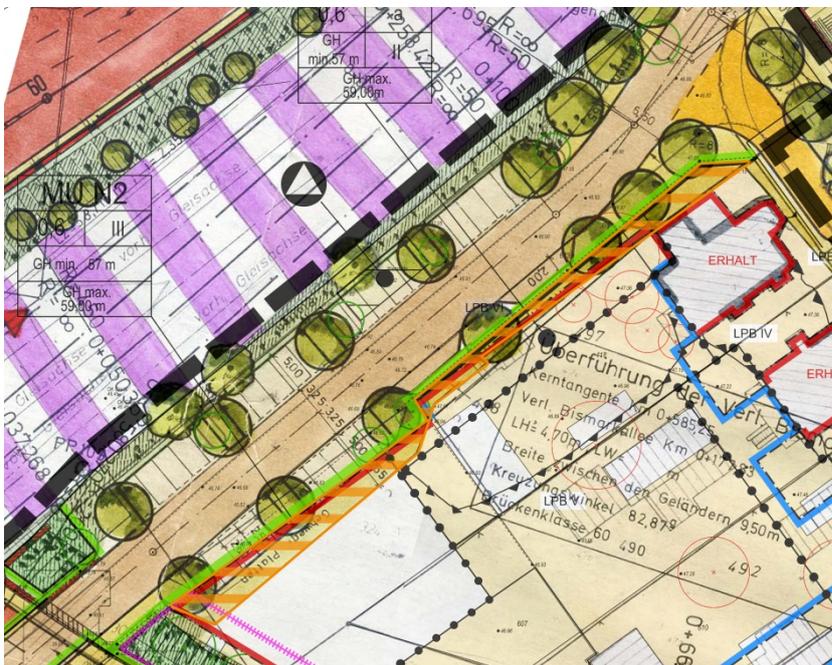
Erika-Keck-Straße – Planfeststellungsbeschluss und Bebauungsplan
